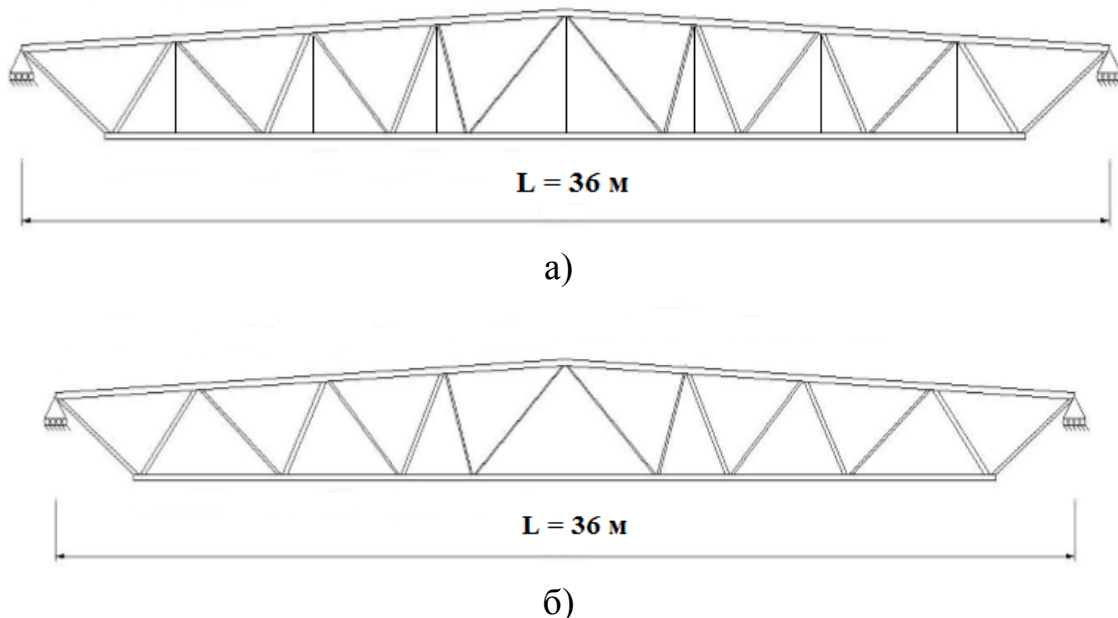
Конструктивна схема досліджуваної ферми а) ферма з розкосами та стояками; б) ферма з розкосами
